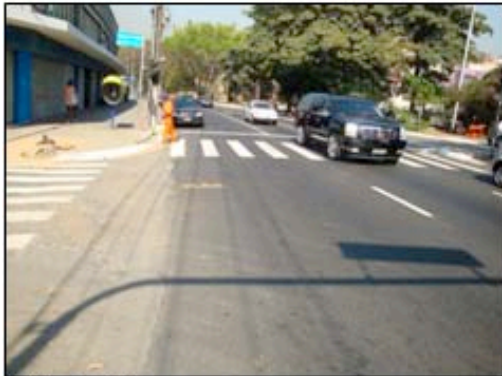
Levantamento da caixa 25 na Rua Ouro Grosso, 778H
